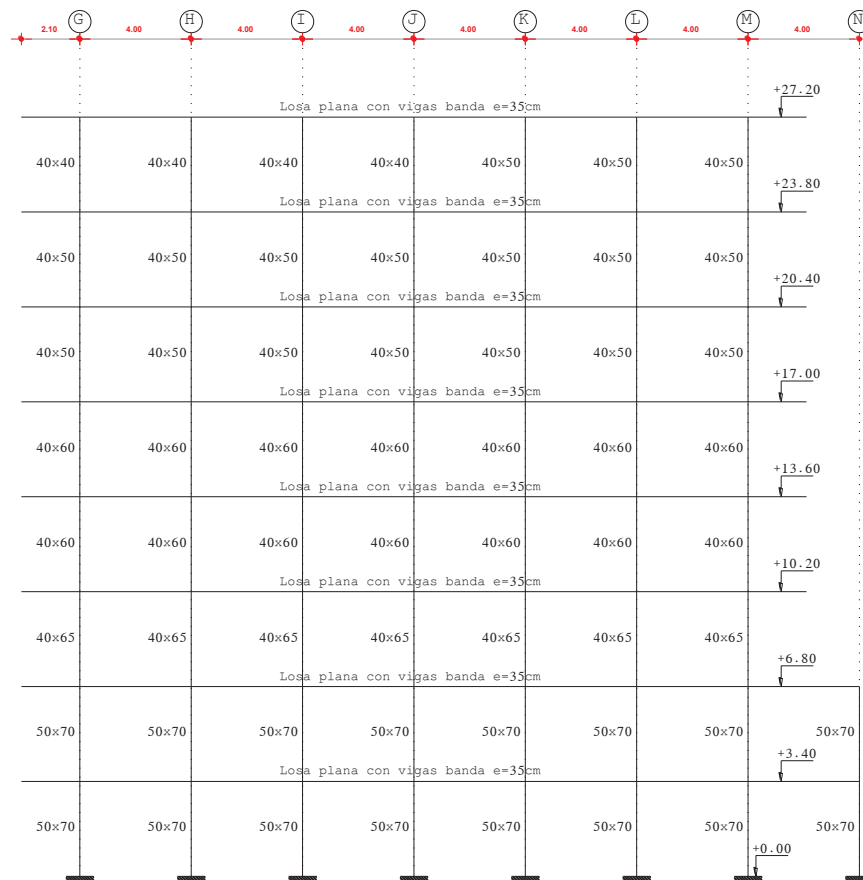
CONFIGURACIÓN ESTRUCTURAL DEL EDIFICIO DE LA F.I.C.A.
